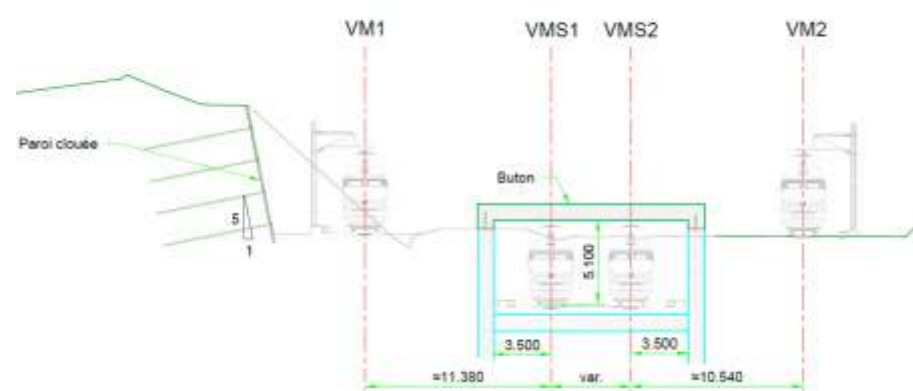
Profil en travers – tranchée ouverte, zone butonnée (EGIS, 2021)
